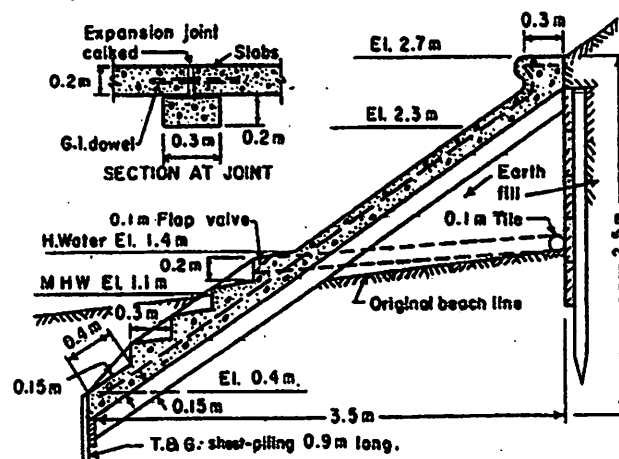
Concrete Slab and King-Pile Bulkhead
